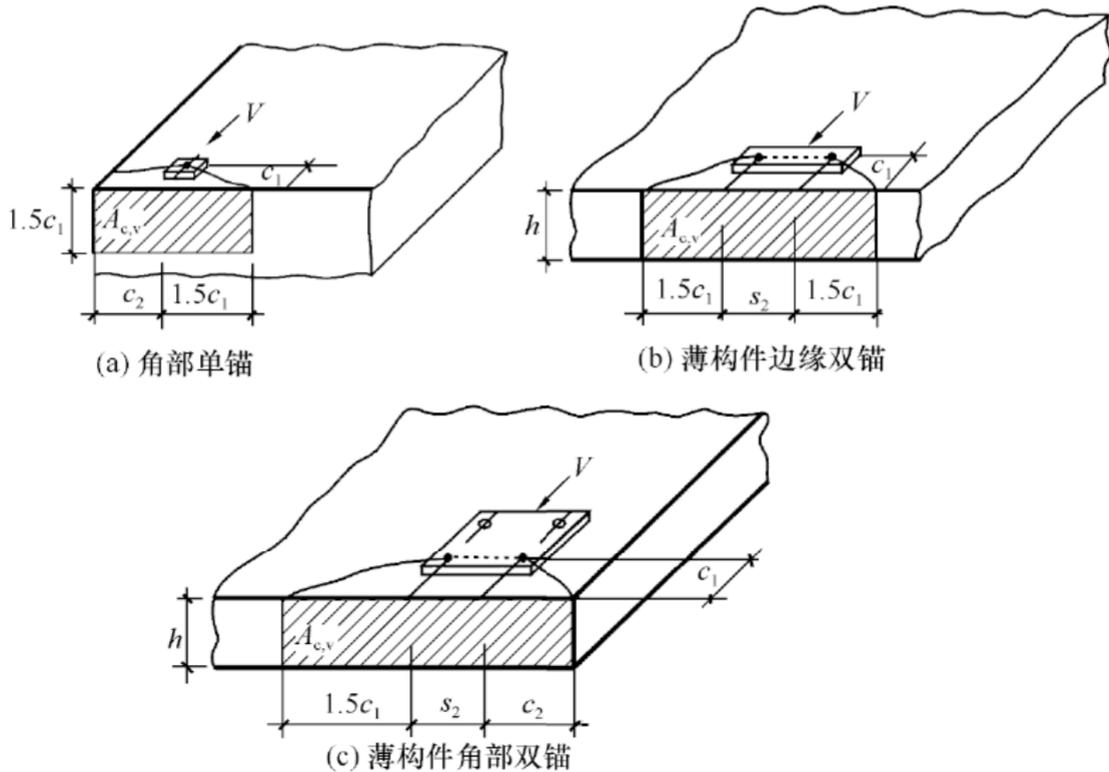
剪力作用下混凝土楔形破坏侧向投影面积
